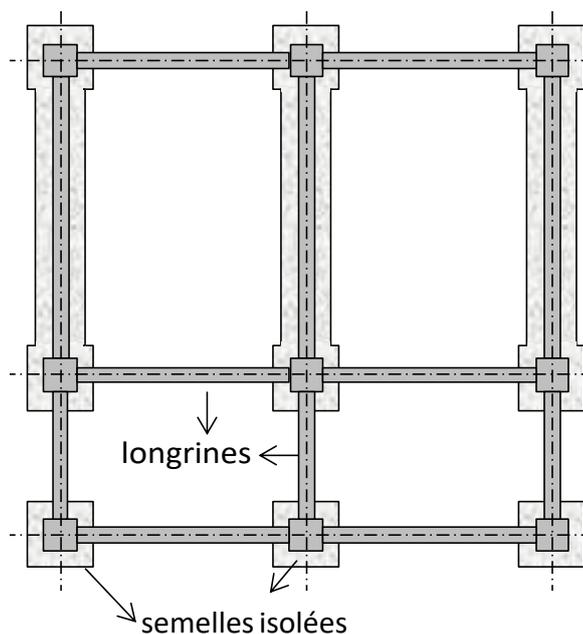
exemple de liaisonnement des fondations isolées par longrines
